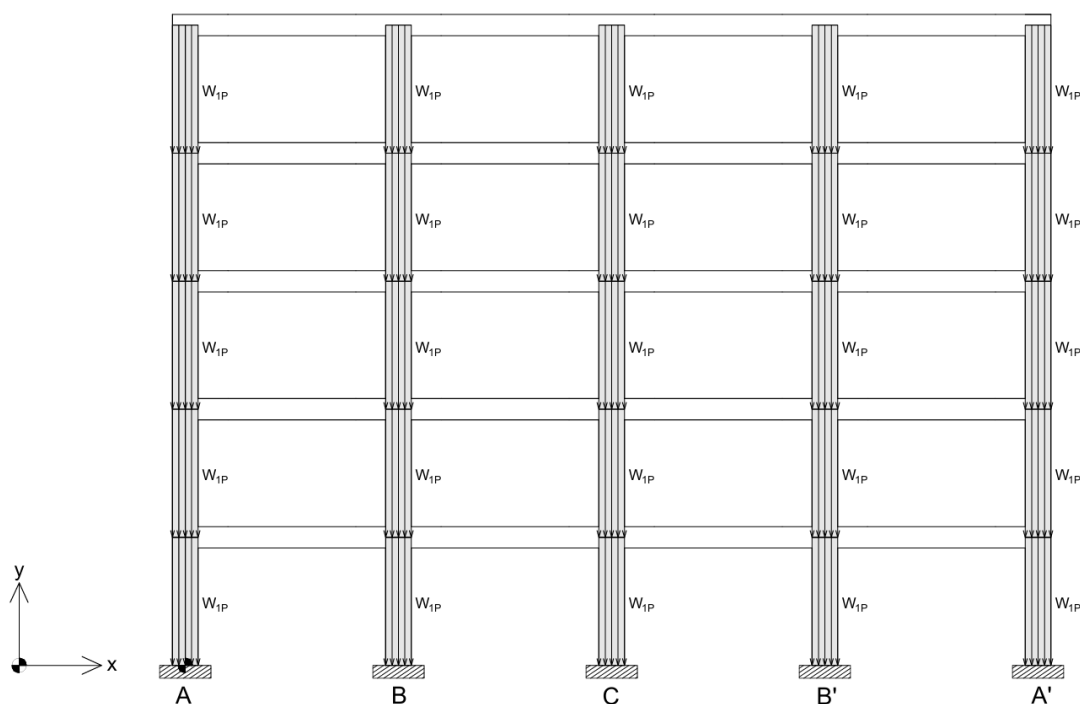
Rappresentazione schematica dei carichi distribuiti nei pilastri
